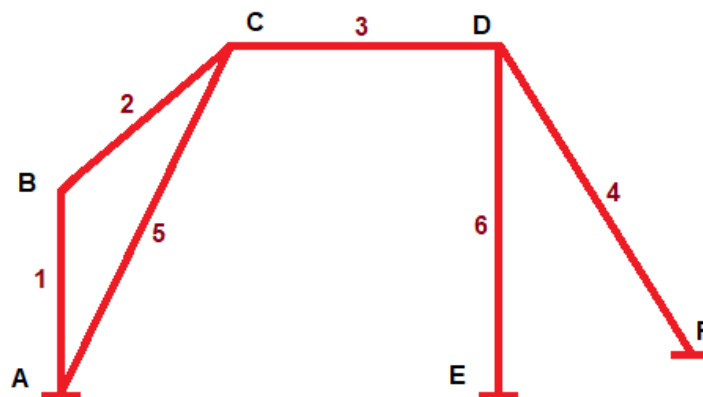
Croquis vista lateral modelo ensayo analítico A.
